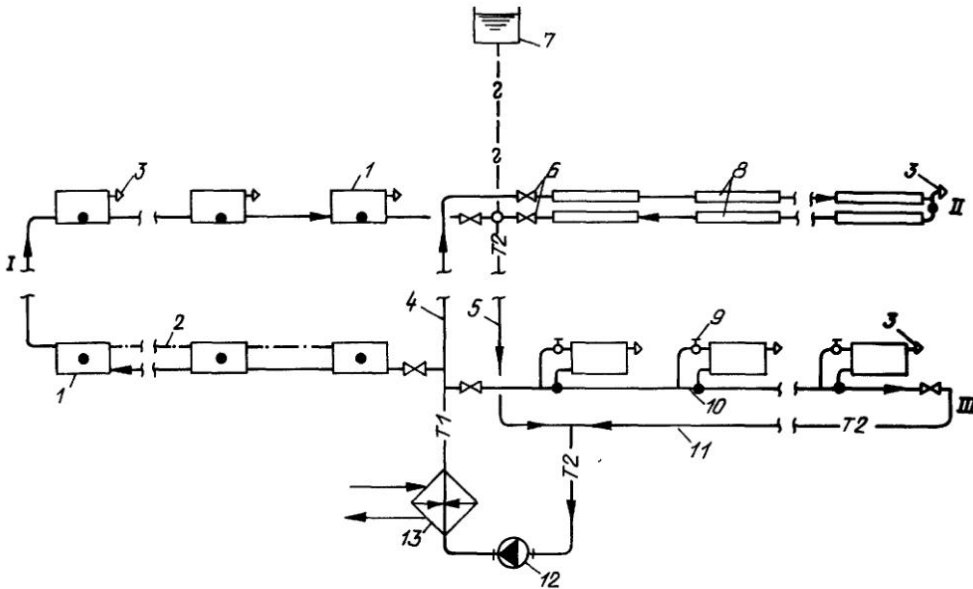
Схема горизонтальной одновентильной системы насосного водяного отопления с ветвями
